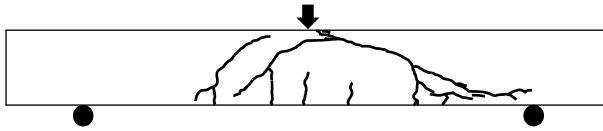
せん断破壊型 S 供試体のひび割れ図
